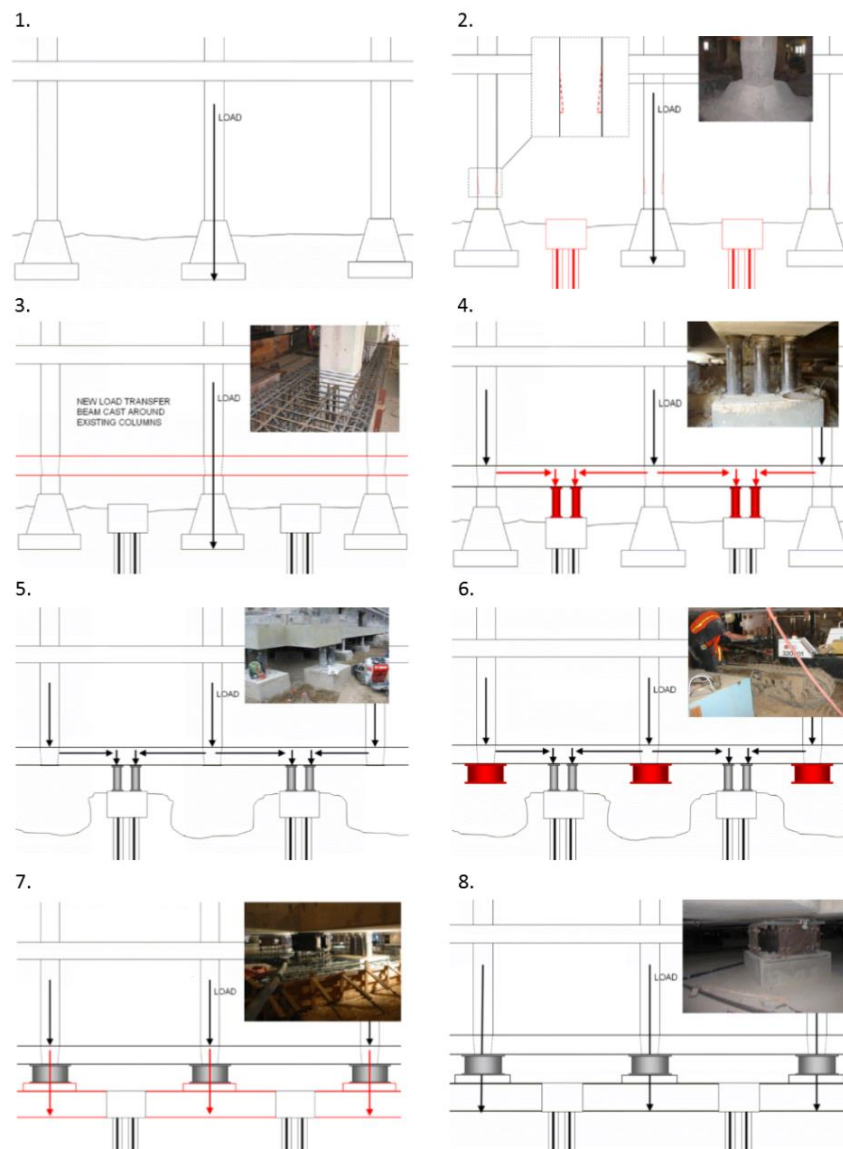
Procedimento de instalação de isoladores em fundações de betão armado (adaptado de Johnson, 2012)
